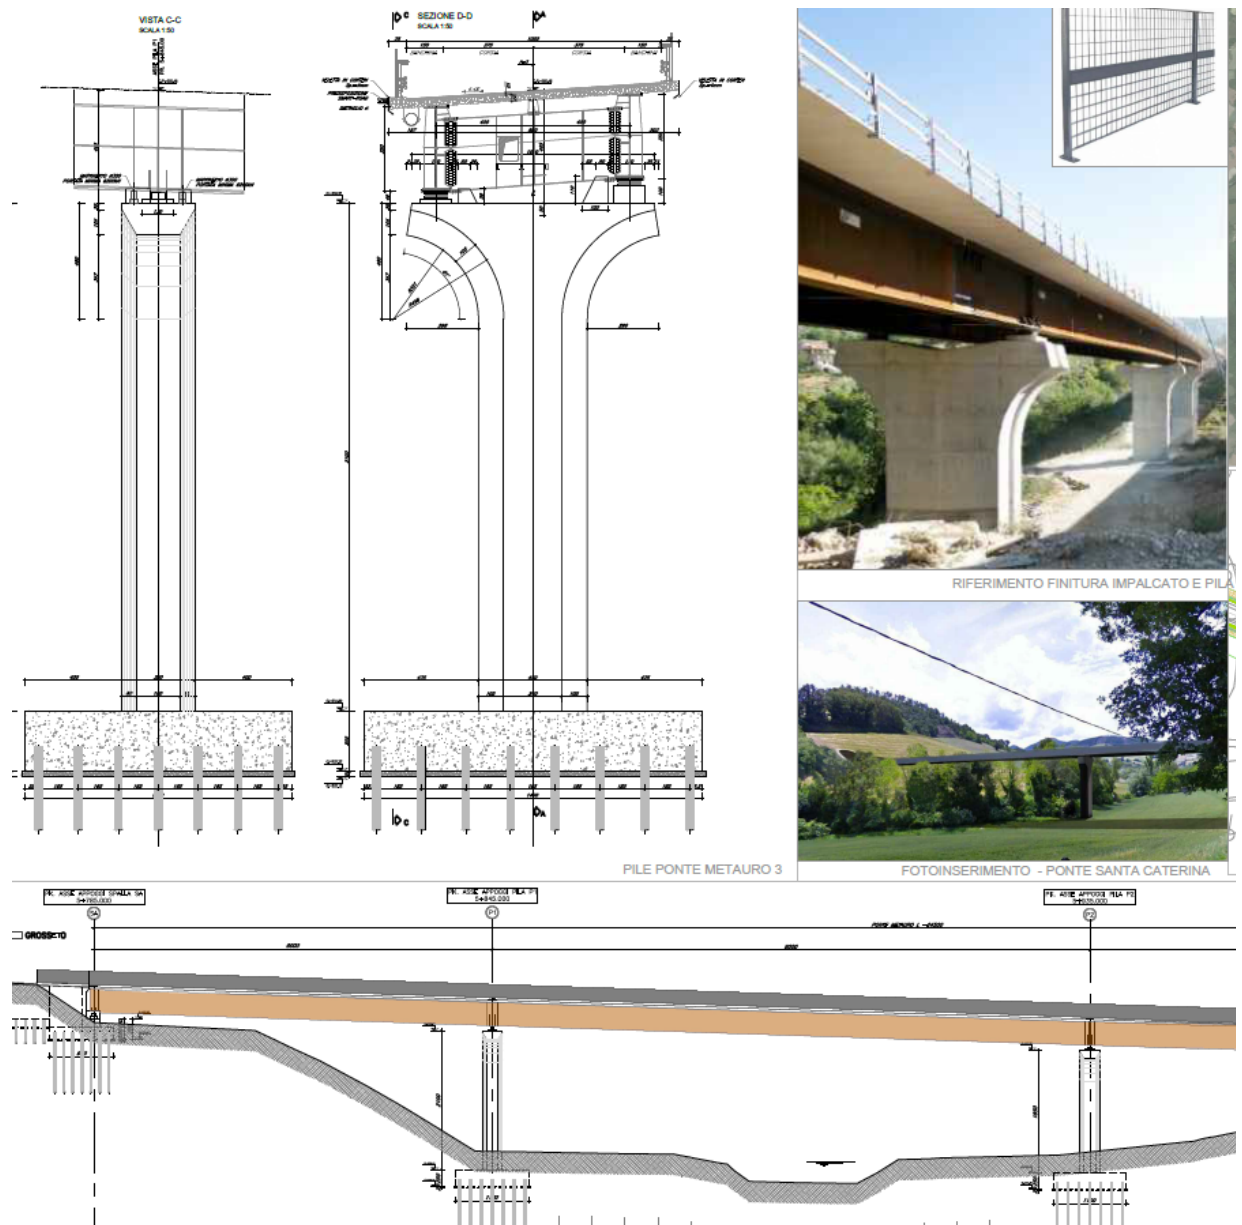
Pile sul Metauro e ponte Santa caterina (estratto T00IA07AMBDI01_A)
